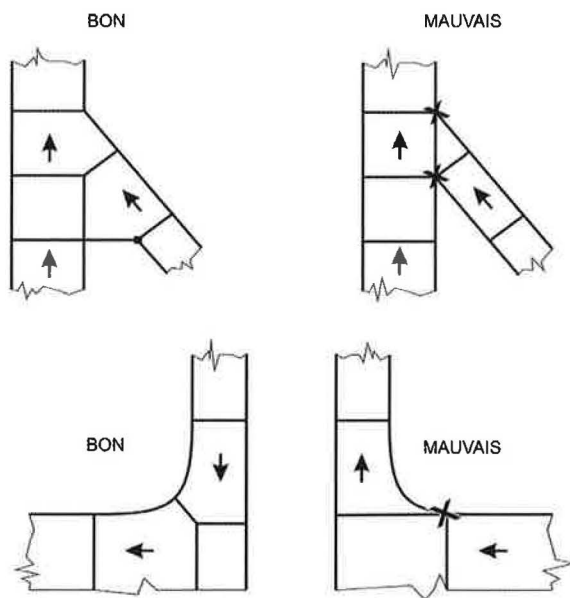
Disposition correcte et incorrecte des joints de retrait
